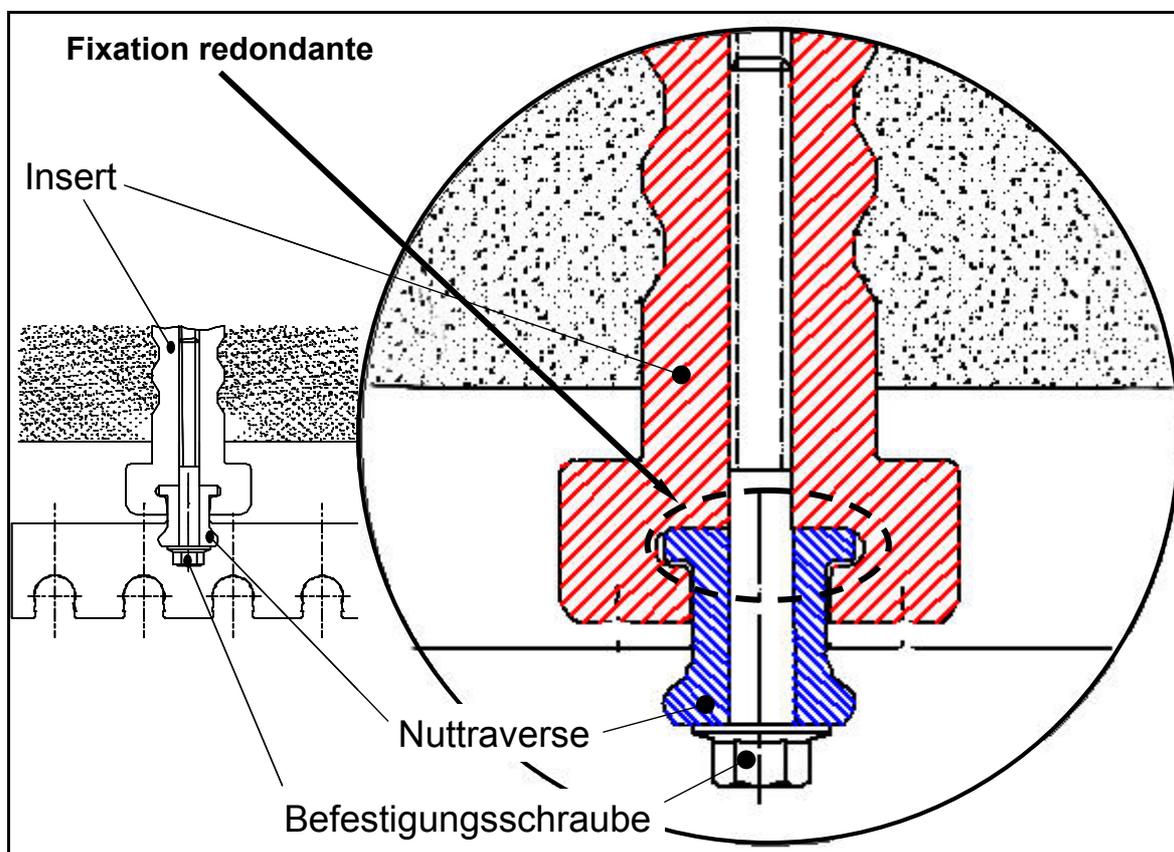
Exemple de différentes fixations redondantes d'un paquet de tôles statoriques sur un bras en porte-à-faux en béton
